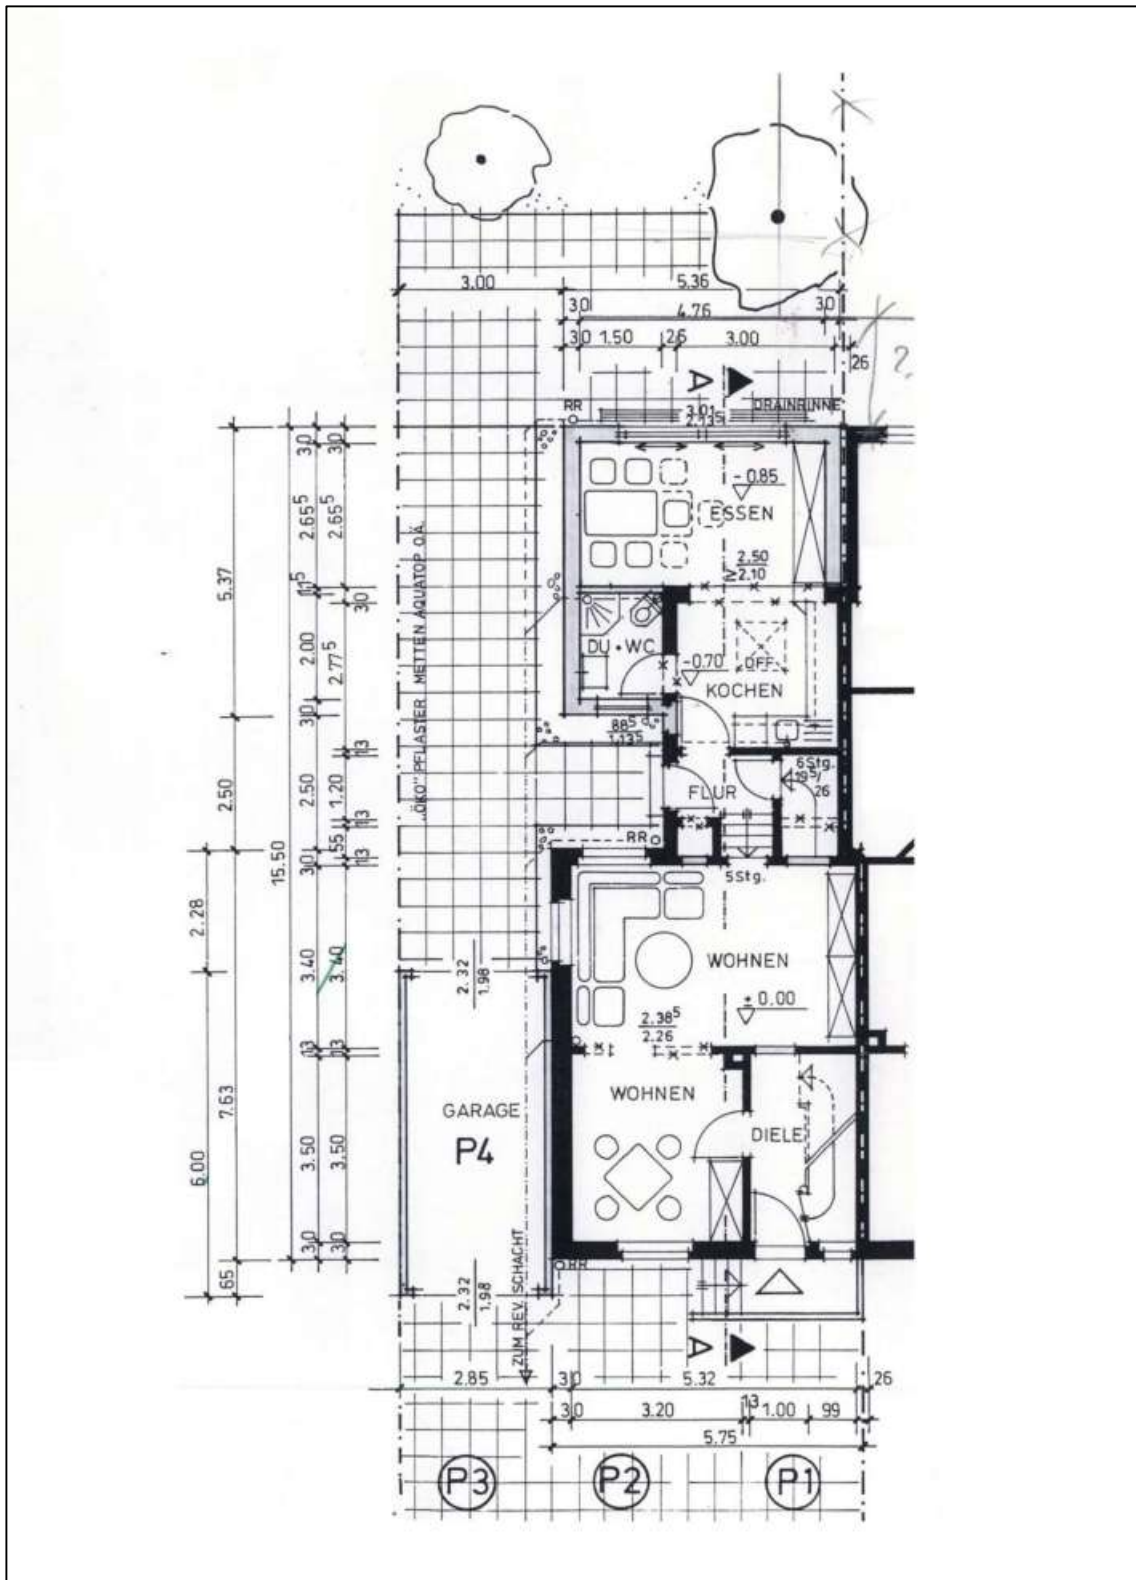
Grundriss vom Erdgeschoss
